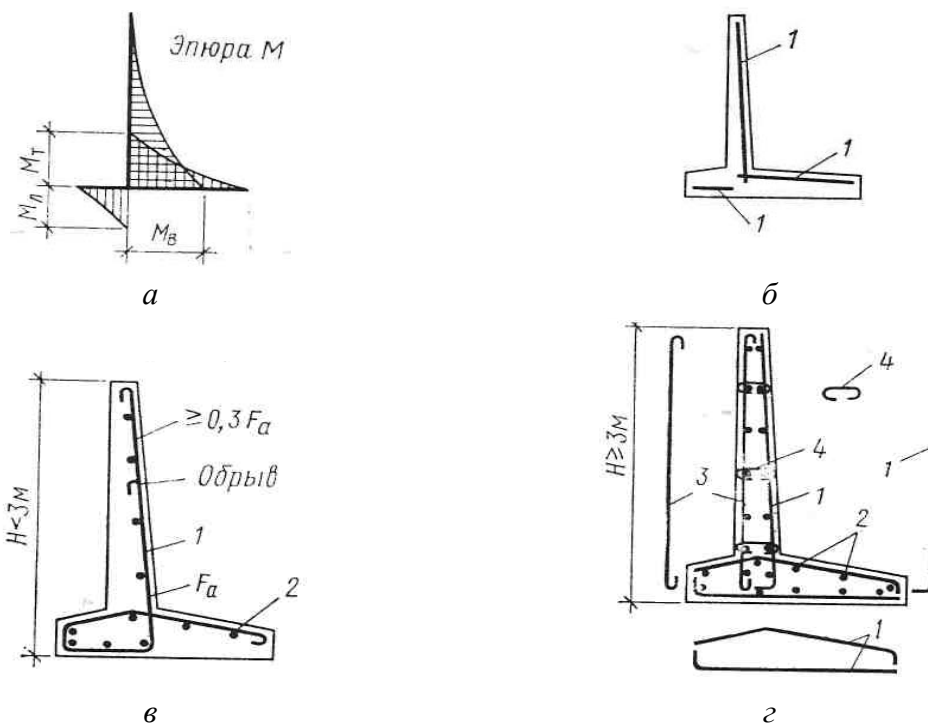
Армирование угловых стенок отдельными стержнями: 1 – рабочая арматура; 2 – распределительные стержни; 3 – конструктивная арматура; 4 – шпилька
